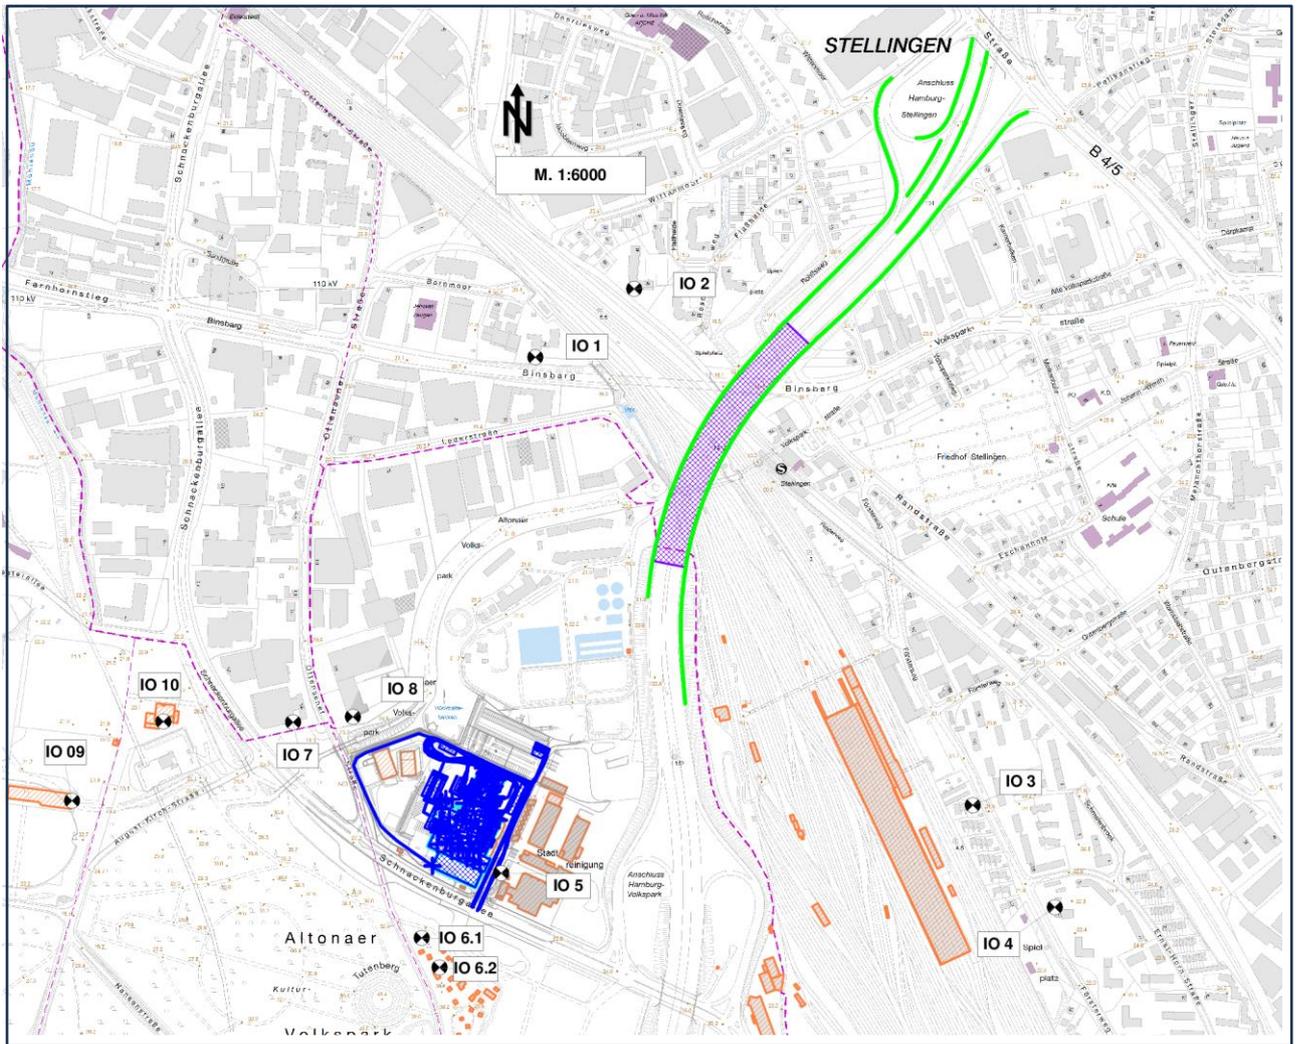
Übersichtsplan mit maßgeblichen Immissionsorten (Schall)
